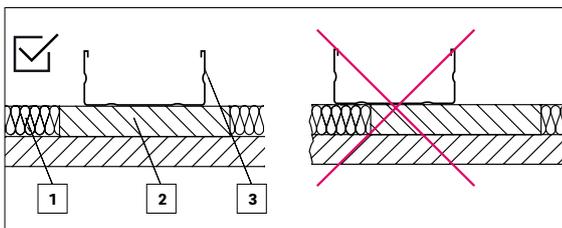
Korrekte Befestigung der Kühldeckenelemente
